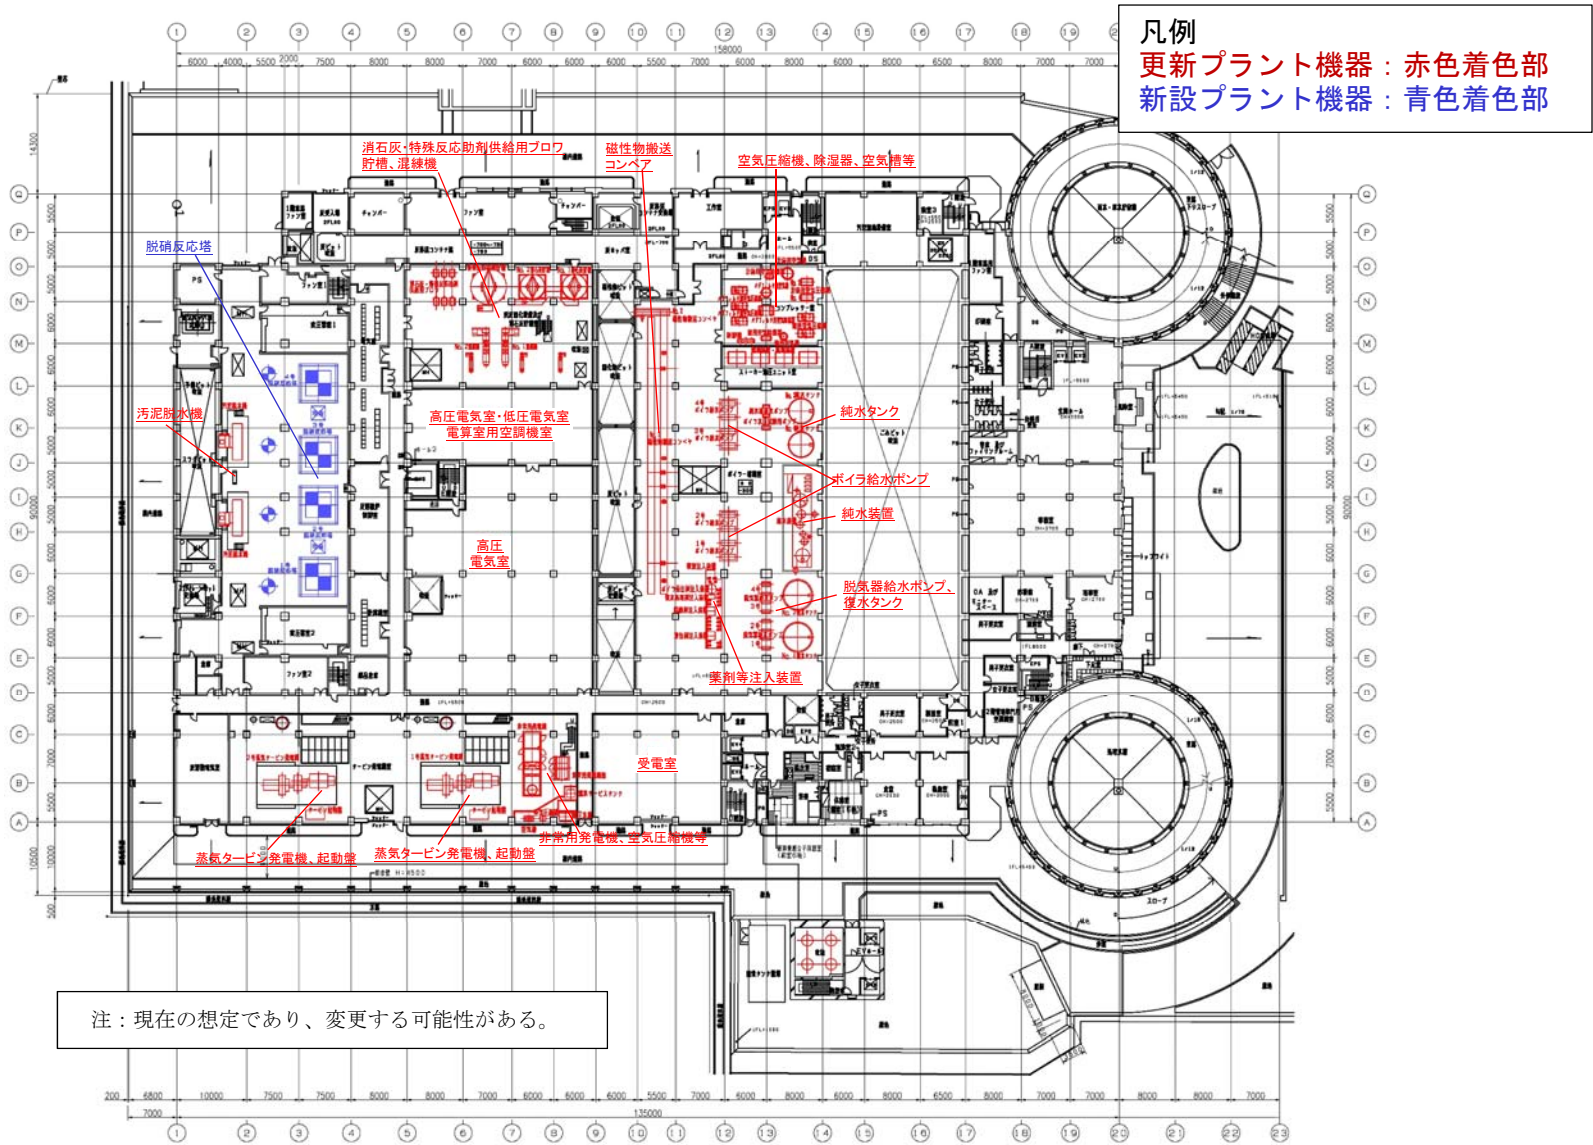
(2) 設備機器の更新箇所 (2階平面図)
